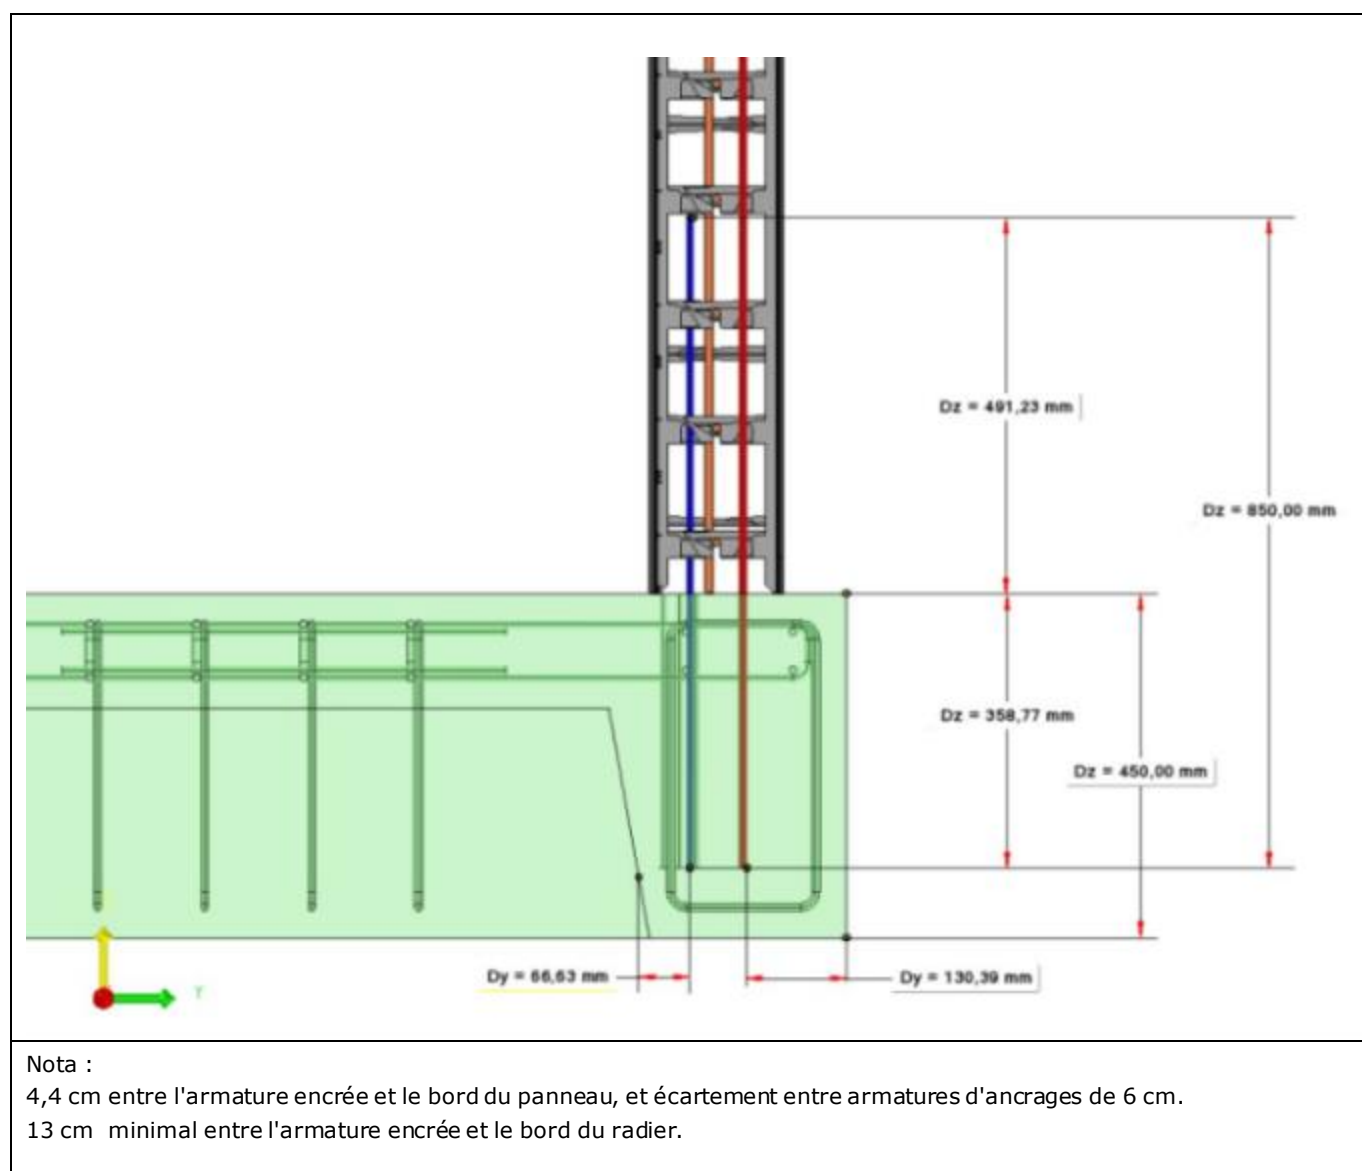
Solution type B - Vue en coupe sur les équerres de jonctions des panneaux ou angles
